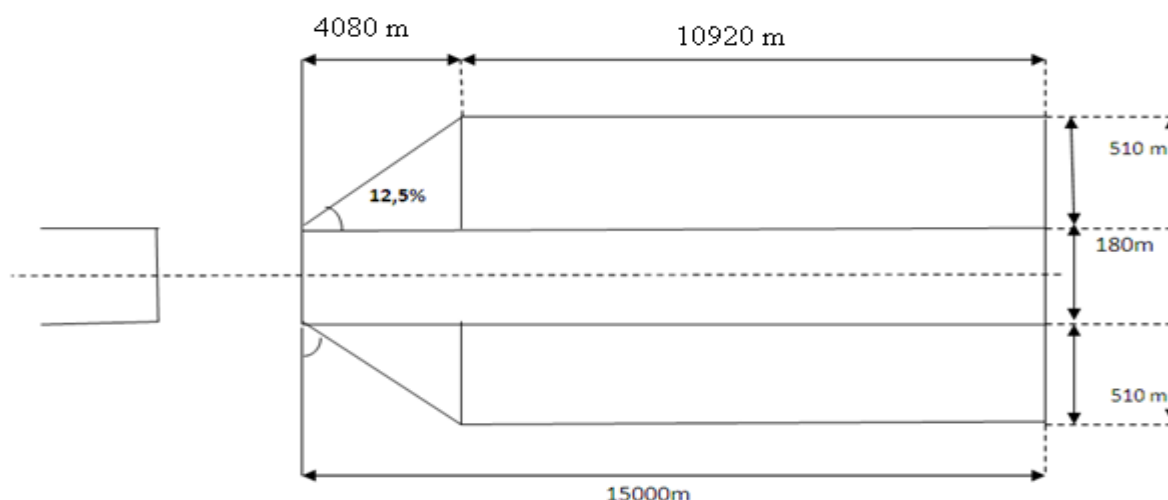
Vue en plan de la surface de montée au décollage.
